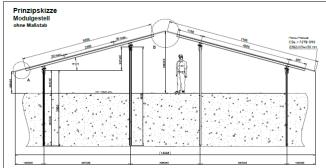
V+E-Plan sowie Schnitt mit Modulflächen
